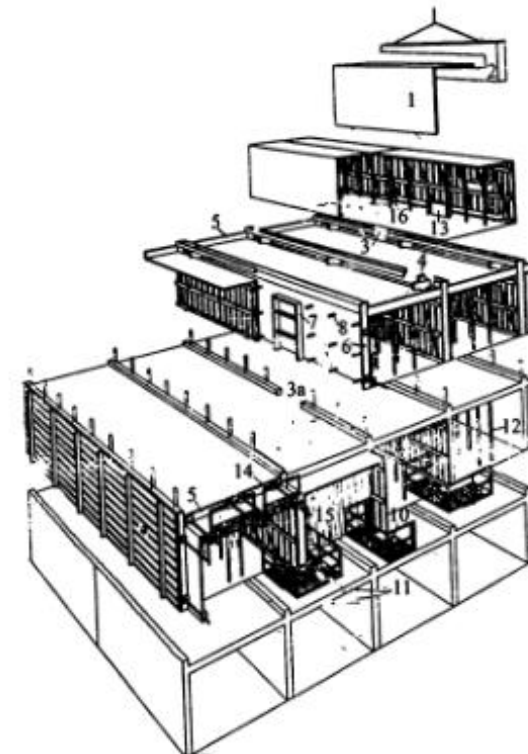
Возведение здания в объемно - переставной (туннельной) опалубке: 1 - Г-образный элемент опалубки (полутуннель), 2 - траверса для подъема опалубки типа "утинный нос", 3 - цокольная опалубка, устанавливаемая на крестообразных вставках. 3а - бетонный цоколь, необходимый для фиксации стены следующего этажа, 4 - крестообразная вставка, 5 - торцевая опалубка перекрытия, 6 - торцевая опалубка стены, 7 - проемобразователь, 8 - стяжка, 9 - крупнощитовая опалубка стен для устройства торцов дома, 10 и 11 - рабочие подмости; 12 - телескопическая стойка, 13 - инфракрасный излучатель, 14 - ограждение; 15 - брезент, закрывающий туннель во время прогрева бетона; 16 - домкрат
